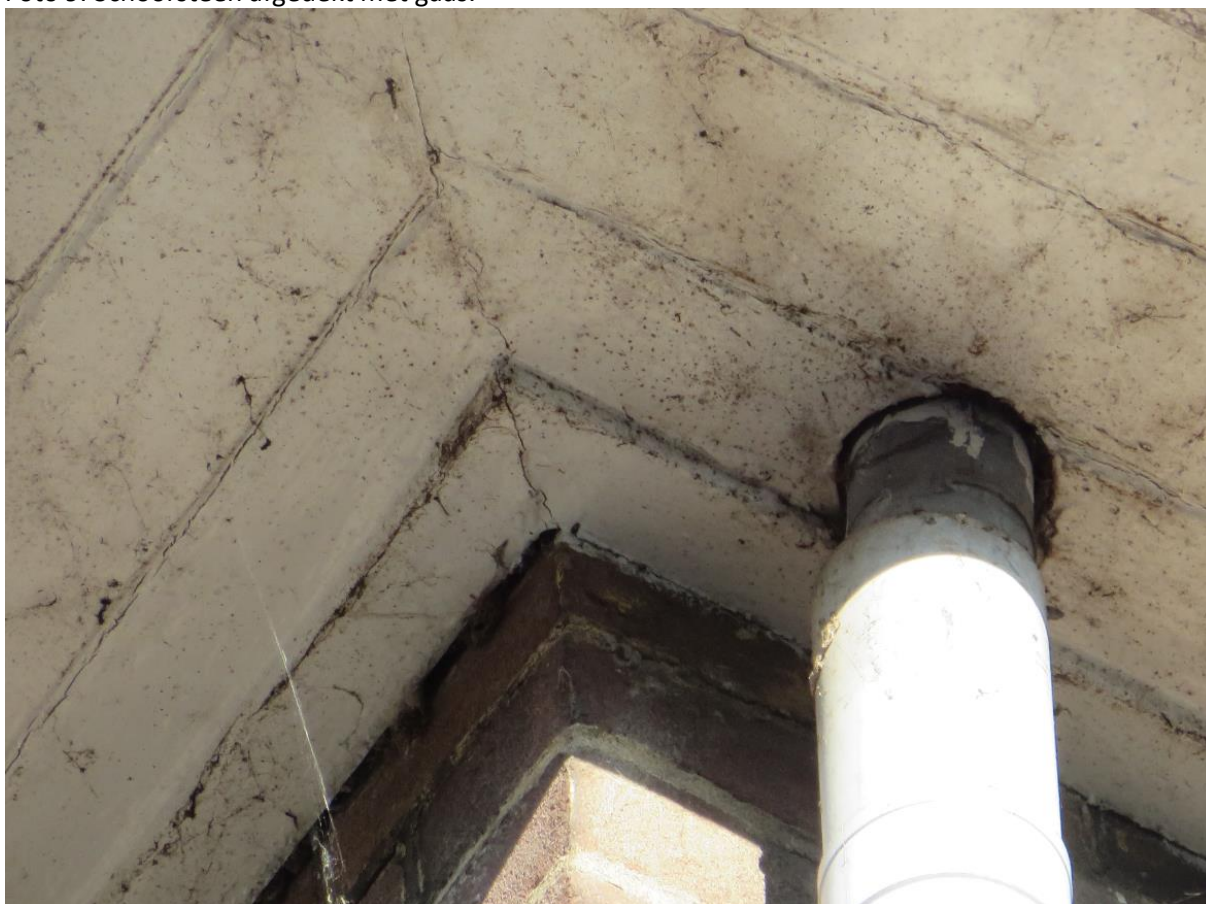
Kieren tussen hemelwaterafvoer en betimmering is mogelijkheid voor dwergvleermuizen.
